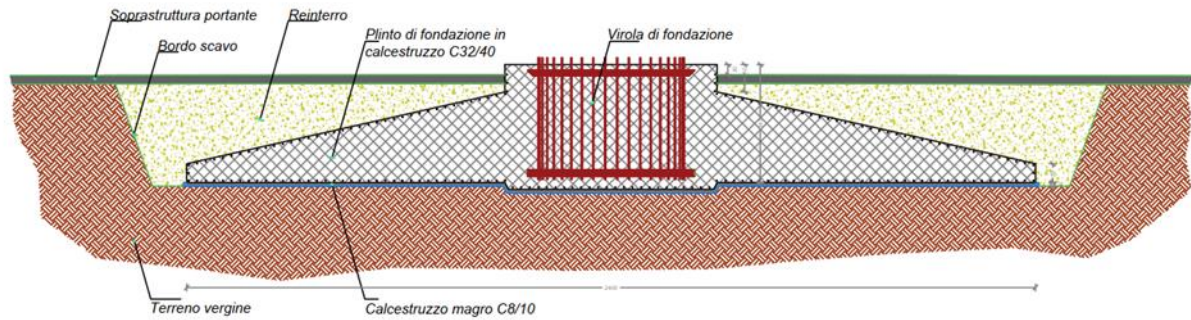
Sezione di progetto della fondazione per l'aerogeneratore NORDEX N163/5.X
